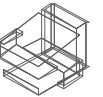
Croquis de la planta de conjunto del proyecto arquitectónico Estación Turística Sostenible.
